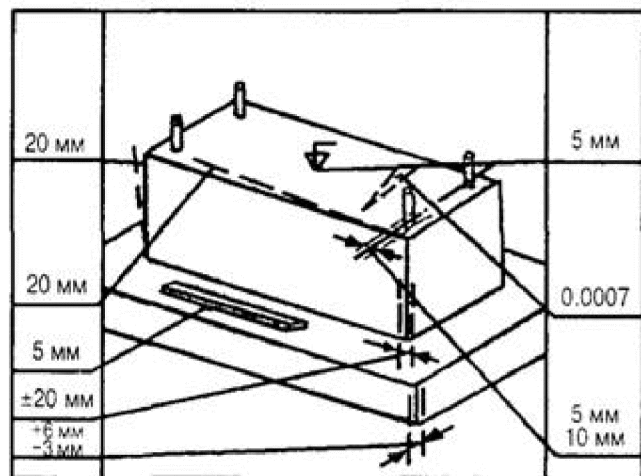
Допускаемые отклонения при устройстве монолитных бетонных и железобетонных фундаментов
